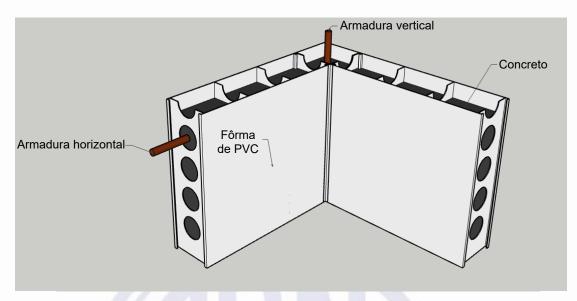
Exemplo de detalhe esquemático dos principais componentes do sistema construtivo de PVC concreto
